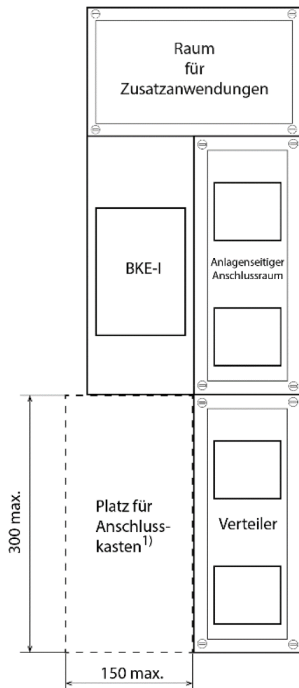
Kundenanlage mit zwei Anschlussnutzeranlagen
